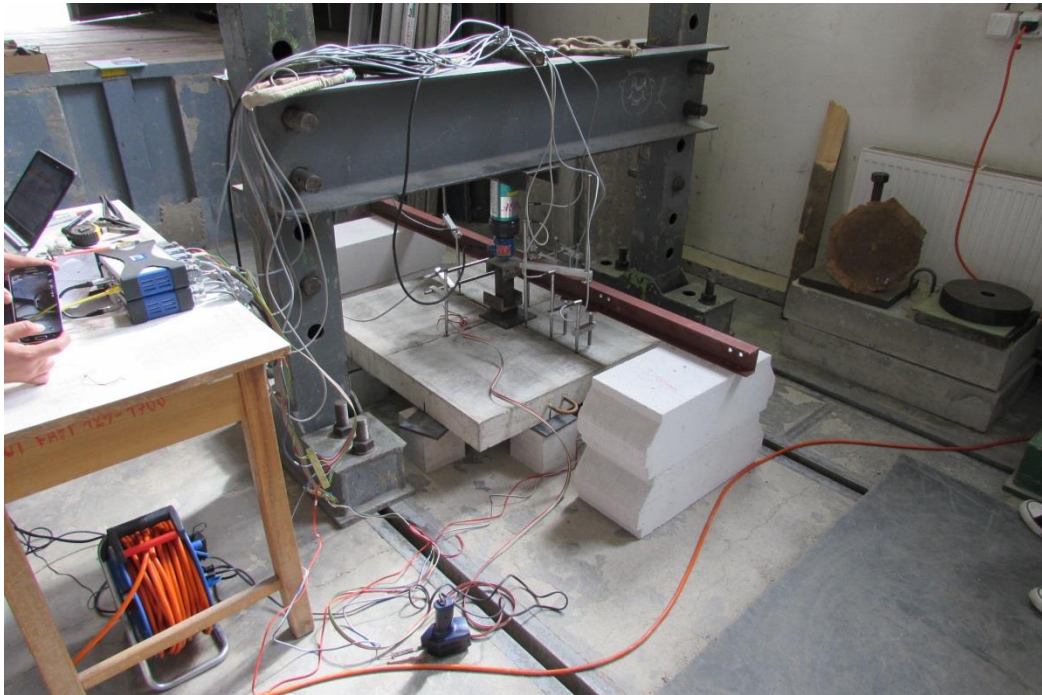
Rozmístění snímačů na horním povrchu testovaných desek
